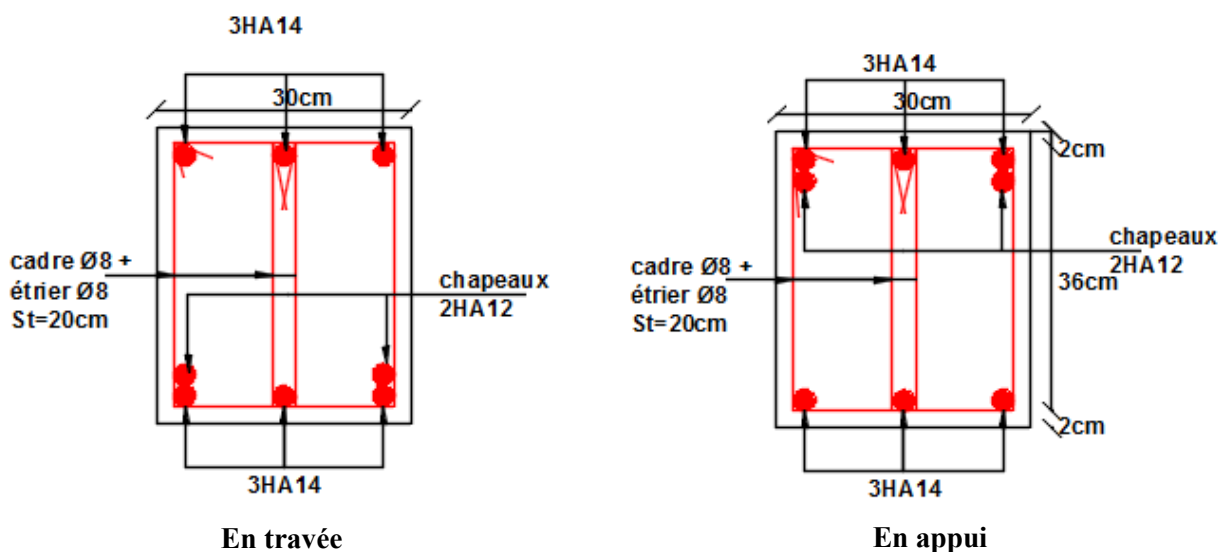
Schéma de ferrailage des Poutres Principales RDC+Terrasse+Poutres secondaire terrasse.
